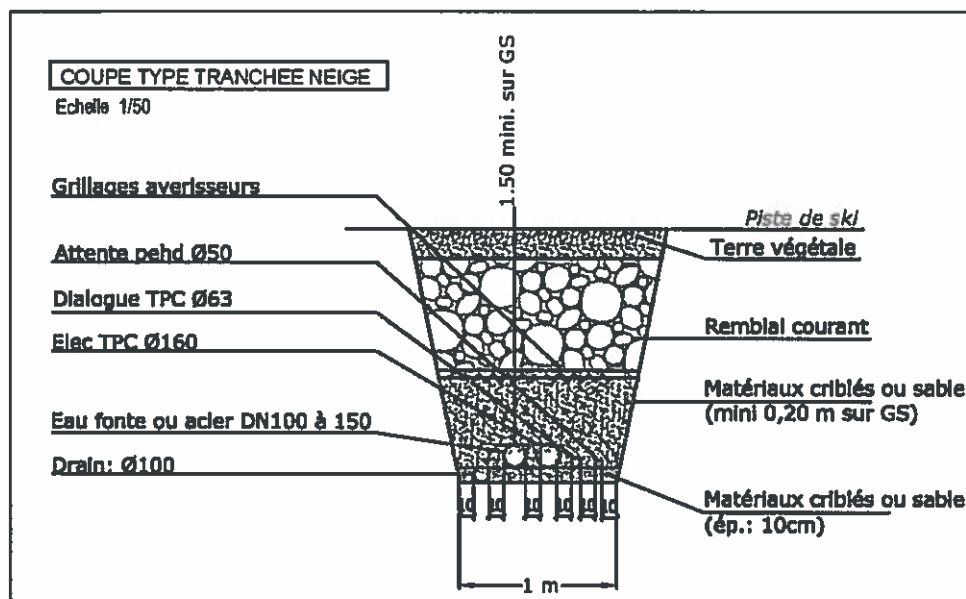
Coupe type de tranchée neige sur le stade d'Isertan
